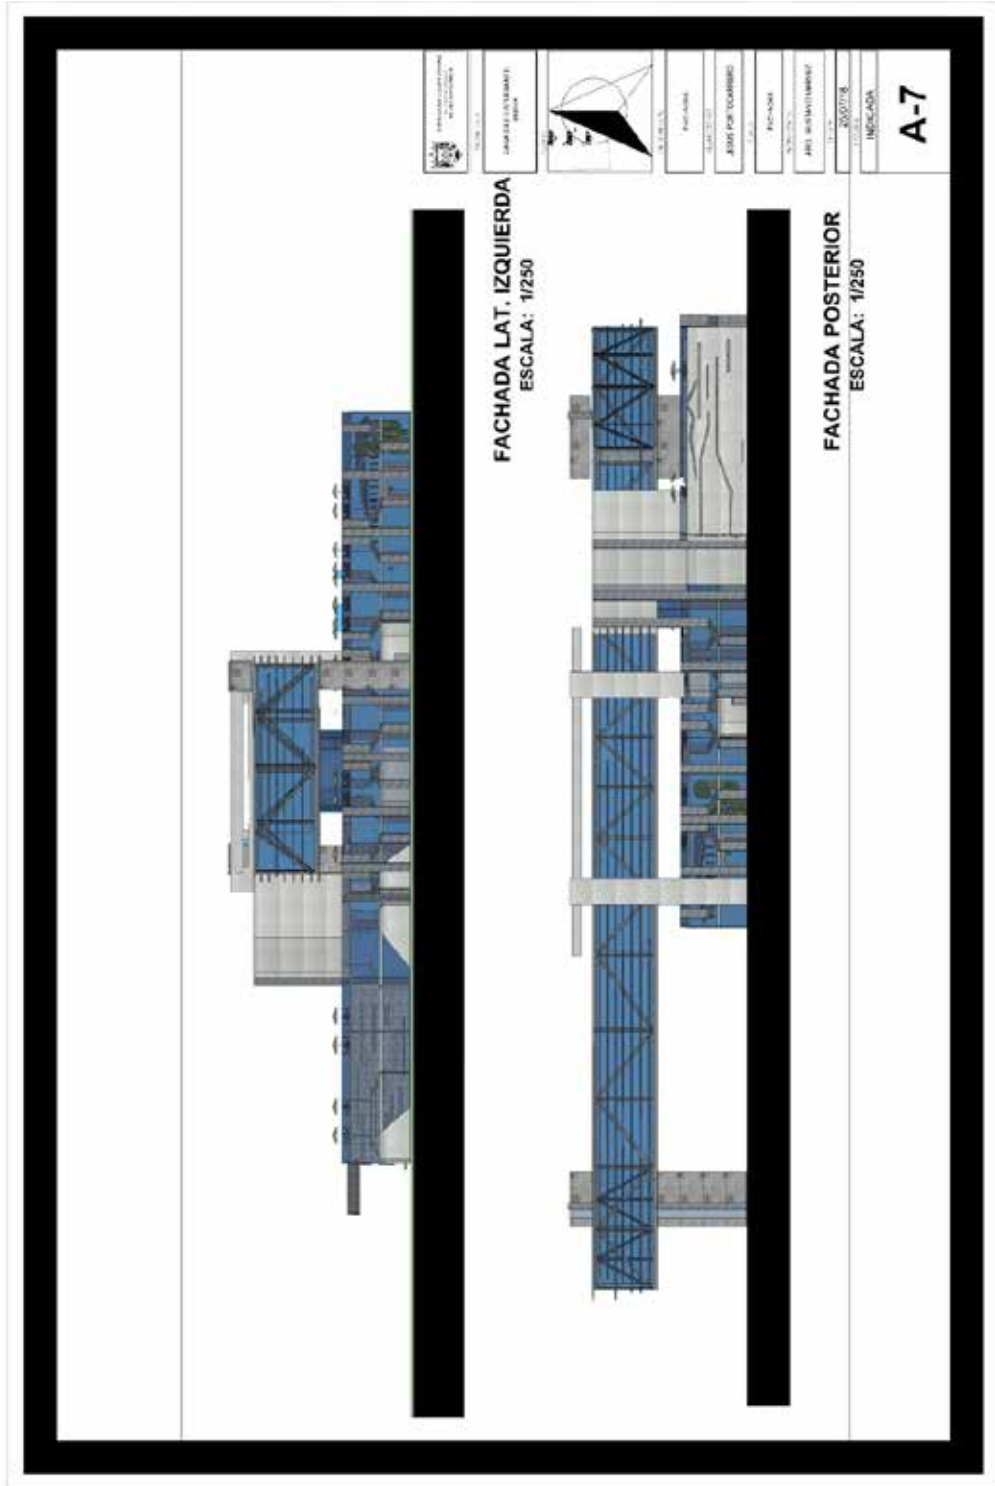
Fachada Lat. Izquierda y Fachada Posterior (2018)
